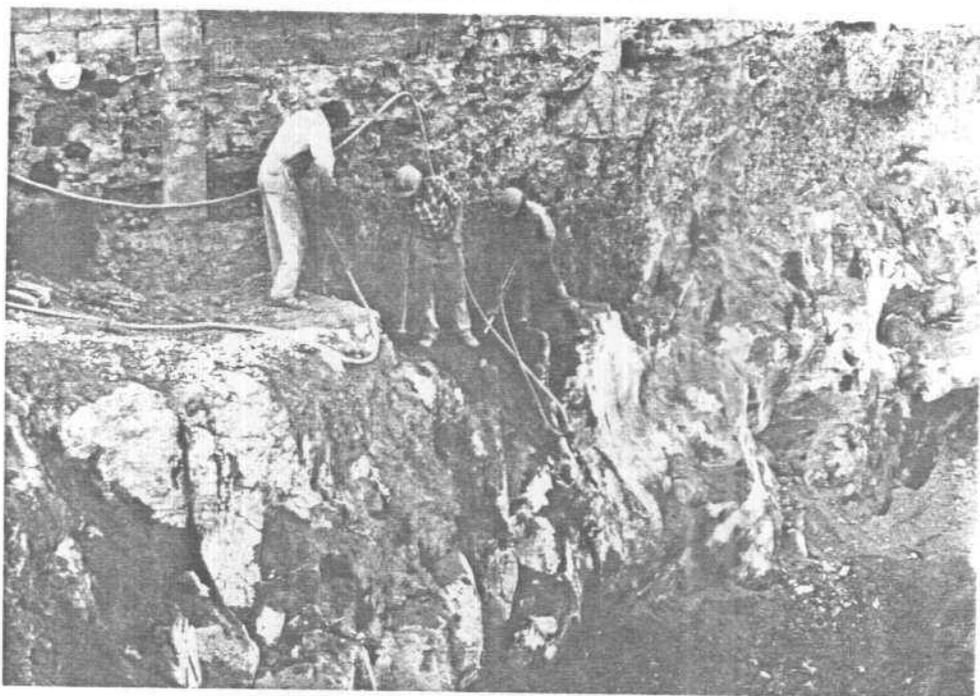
Cata 5. Debe destacarse la potencia y escasa fisuración del basalto.
